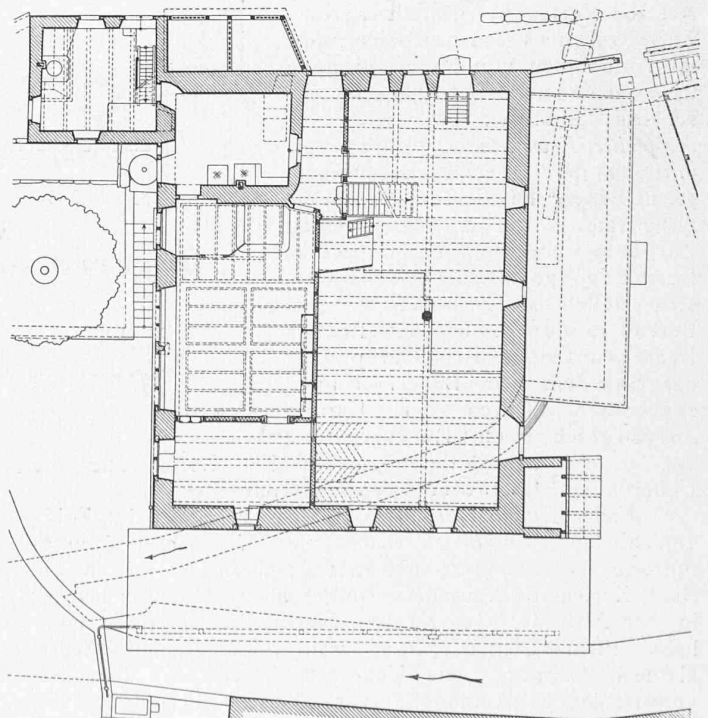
Grundriss vom Erdgeschoss.
